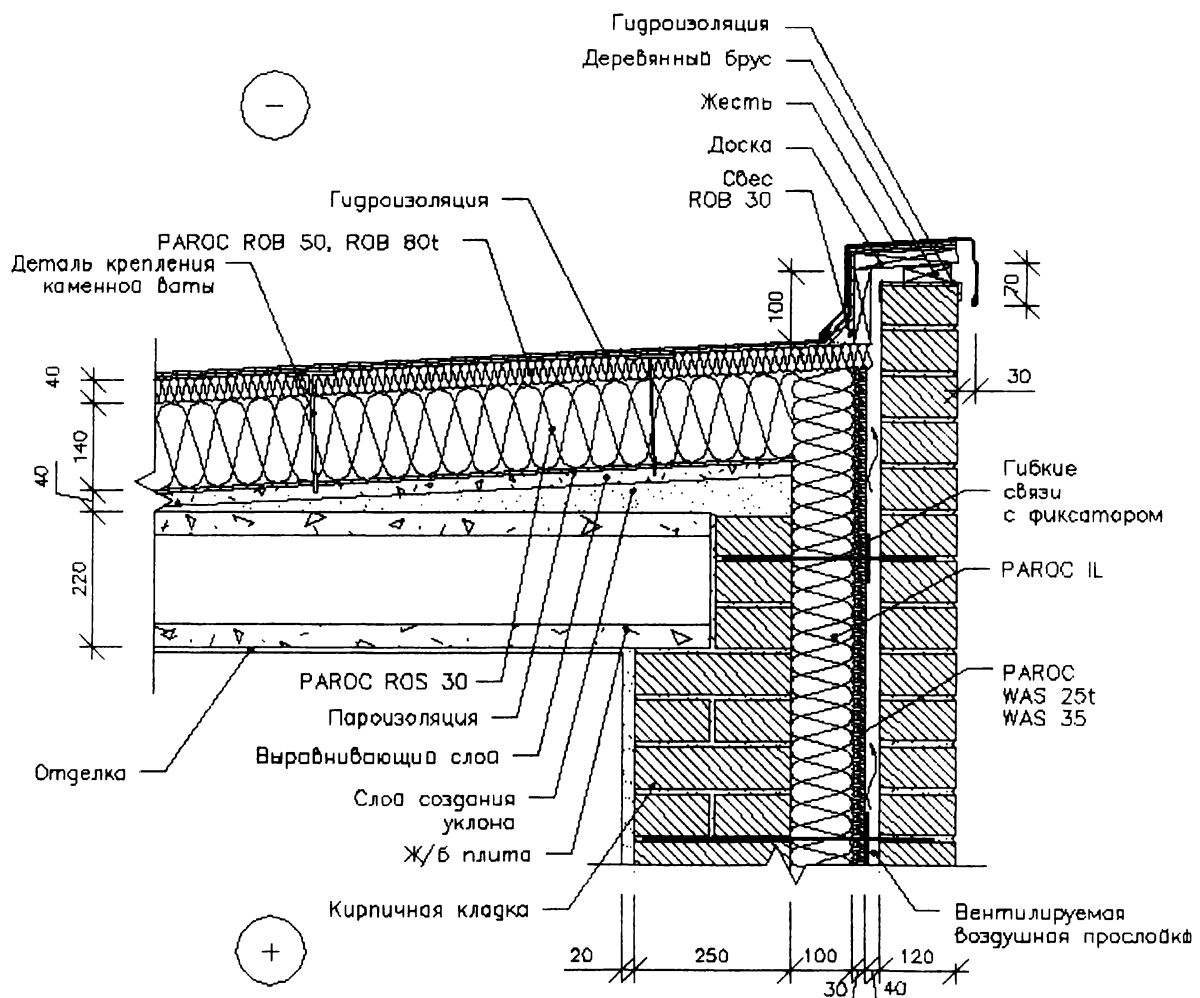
Устройство совмещенной вентилируемой крыши парапета
